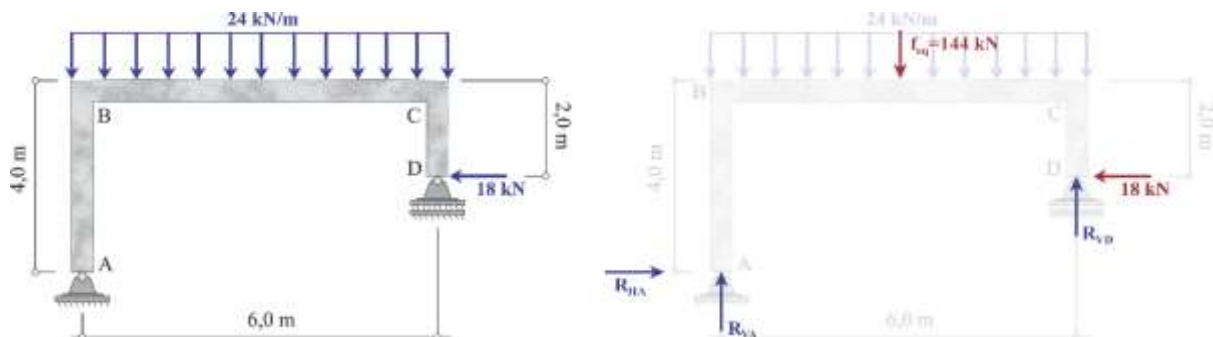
Exemplo de Pórticos em Estruturas Metálicas
